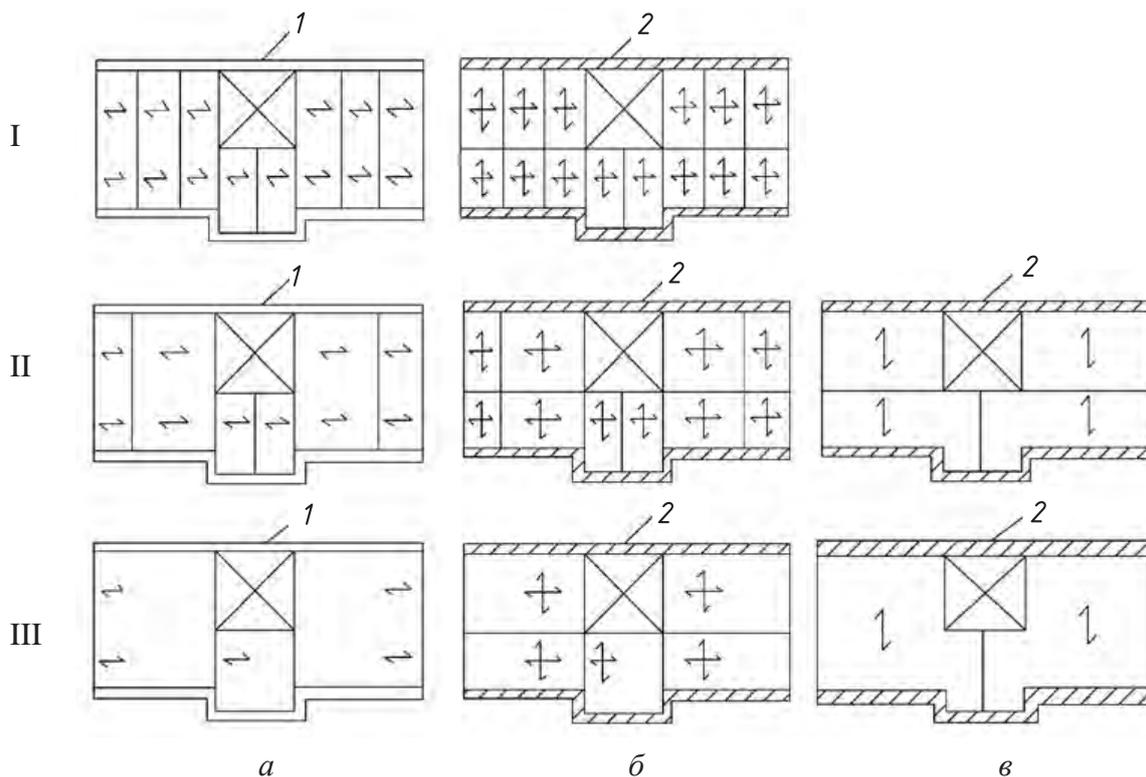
Стеновые конструктивные системы: а — поперечно-стеновые; б — перекрестно-стеновые; в — продольно-стеновые с перекрытиями: I — малопроектными; II — среднепроектными; III — крупнопроектными: 1 — ненесущая стена; 2 — несущая стена
